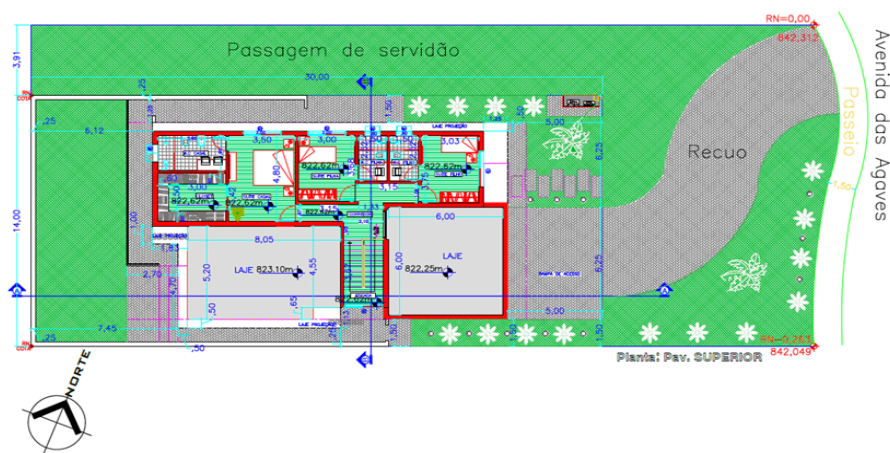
Imagem da planta do pavimento superior do projeto arquitetônico
